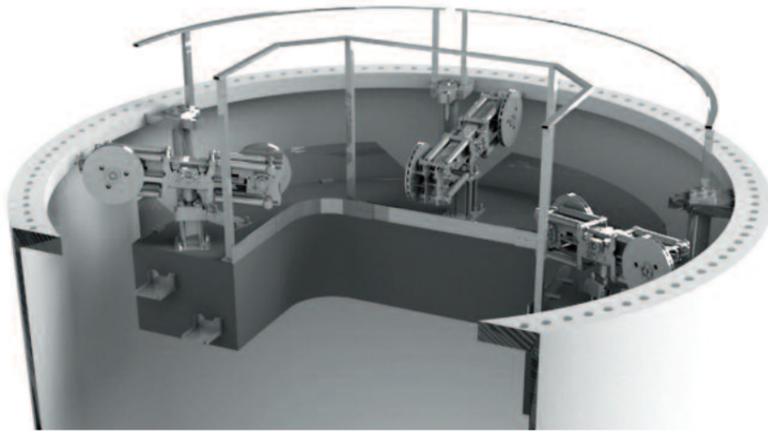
Kompakter ESM-Tilger für die 2. Turmeigenschwingung
